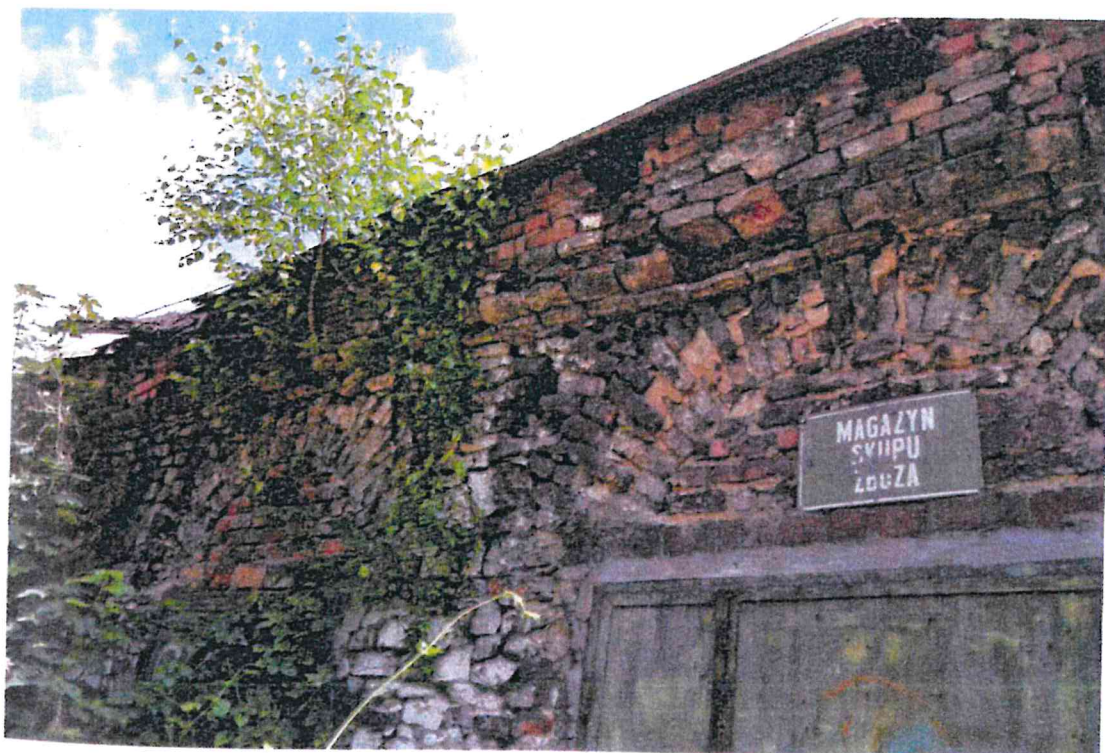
Budynek walcowni, elewacja północna z dobudówką
